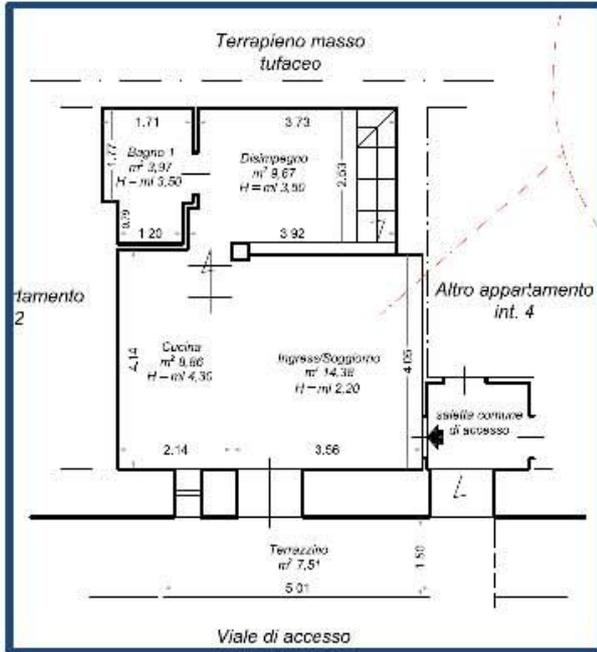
Stralcio Planimetria dell'attuale stato dei luoghi.
